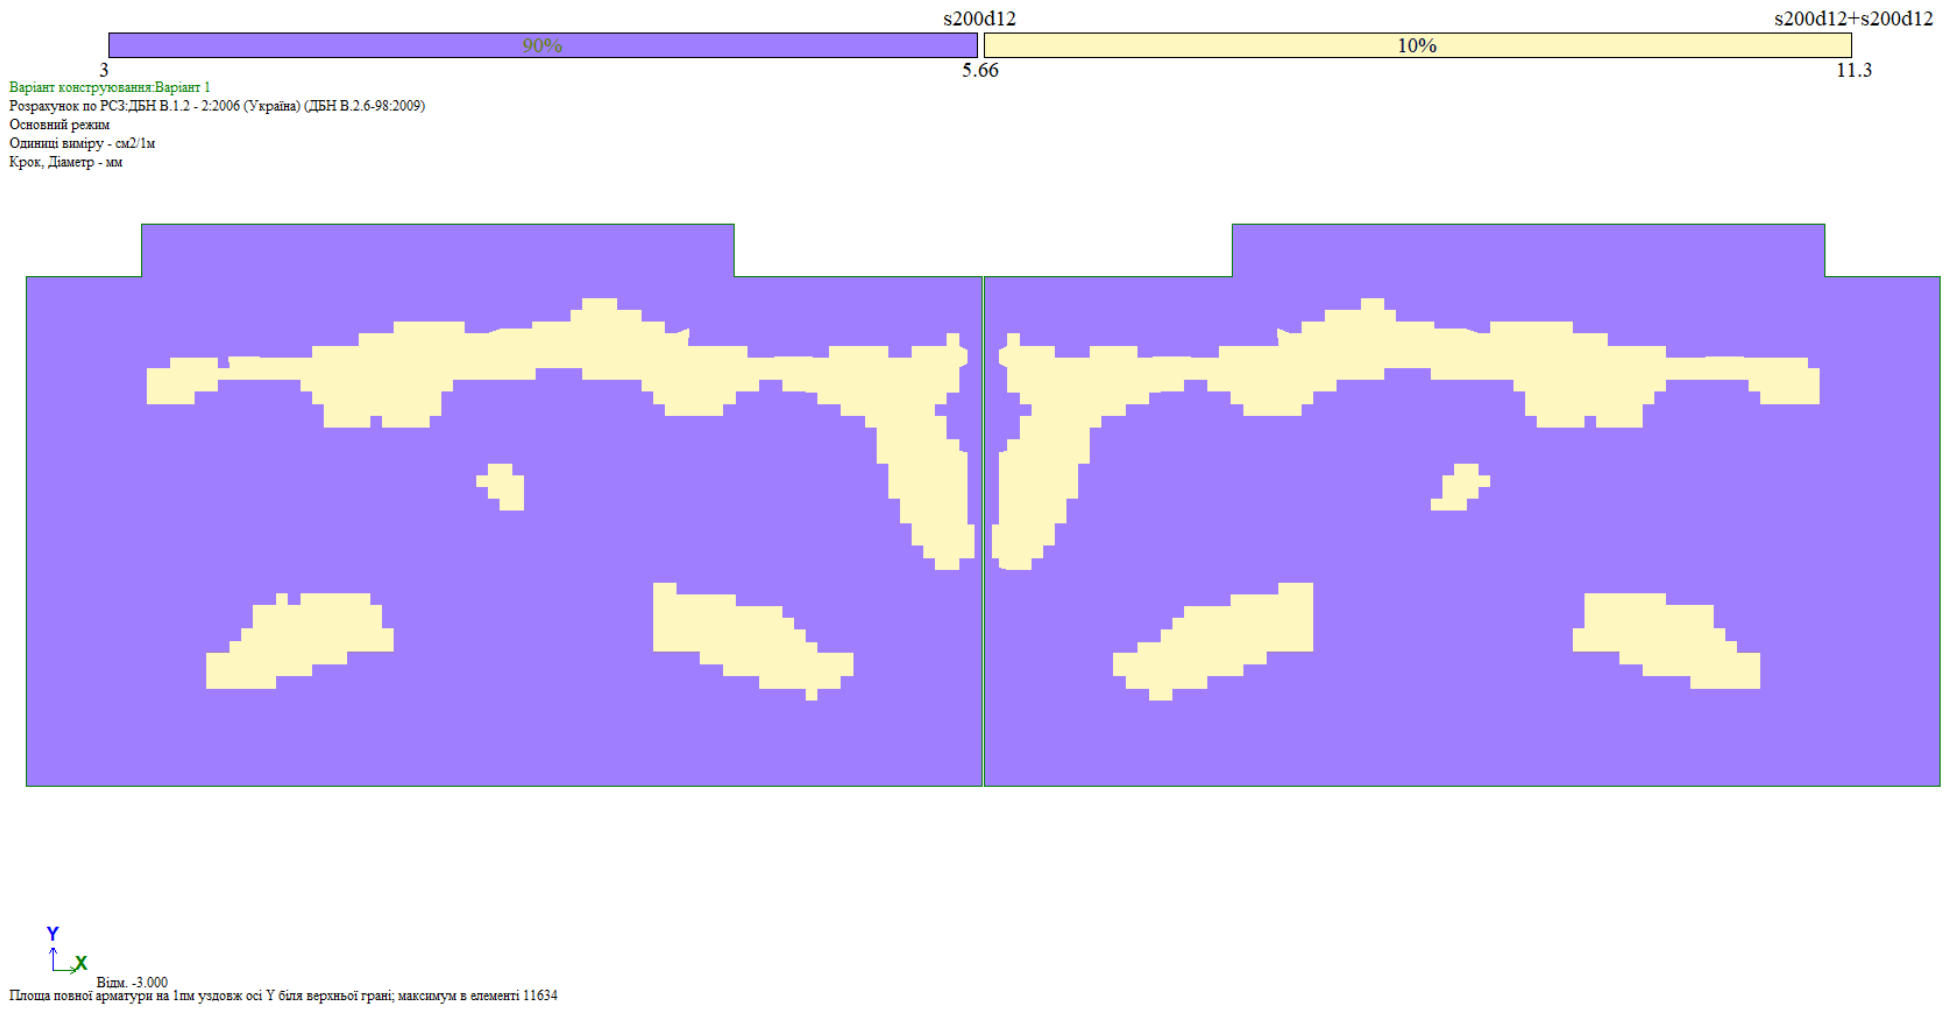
Армуння верхньої зони вздовж осі Y (см²/1м) фундаментної плити
